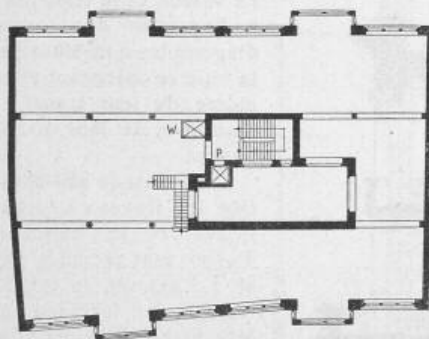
Grundriss vom I. Stock 1:500.
